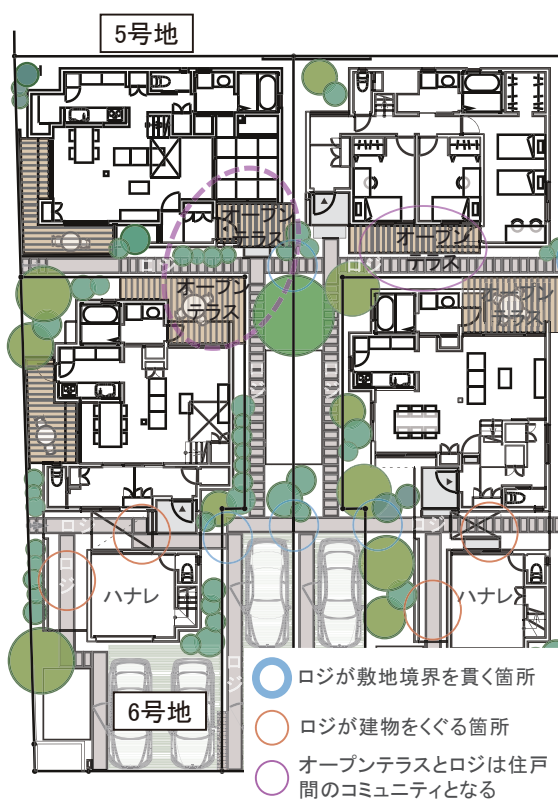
分譲住宅D：5、6号地平面図 1/300
